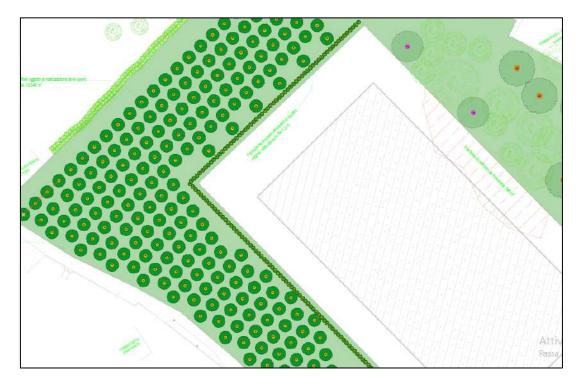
Estratto dalla tavola di progetto con rappresentazione della fascia tampone
